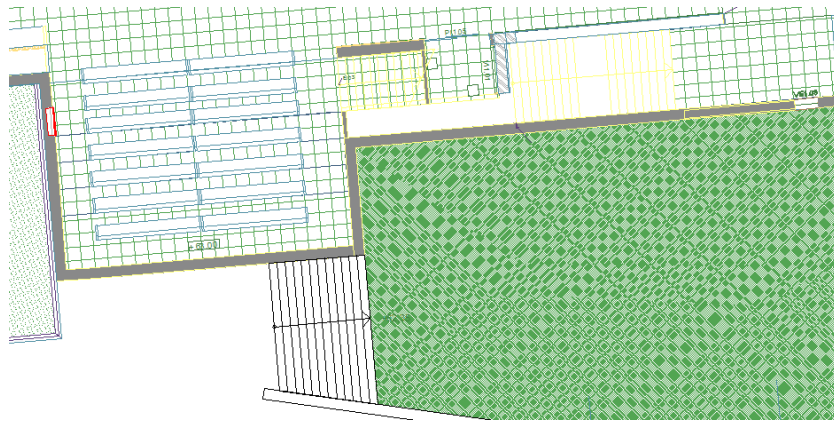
Planta do piso 1, destacando o muro MB3.1, MB3.2 e MB3.3 em contacto com o terreno.
